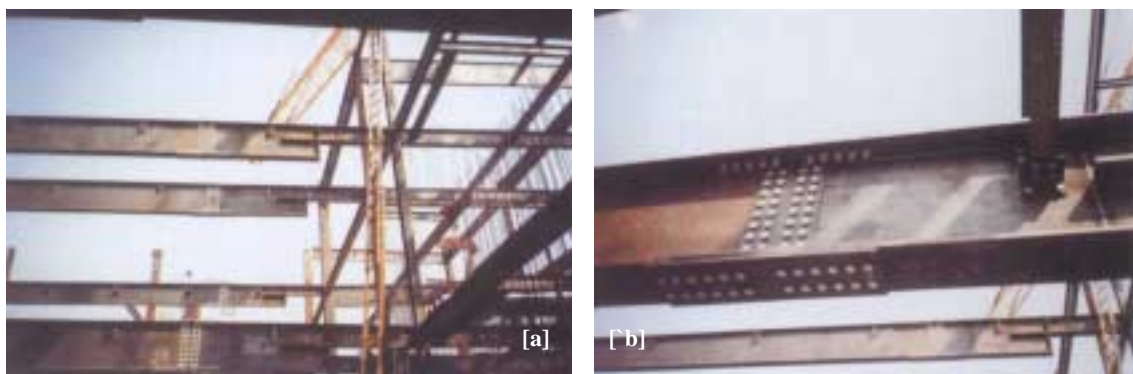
Vistas, em detalhe, das soluções dadas para a execução das vigas: (a) redução da altura da viga para a passagem de dutos; (b) juntas parafusadas dos perfis subdivididos. Fonte: DIAS (2001).
